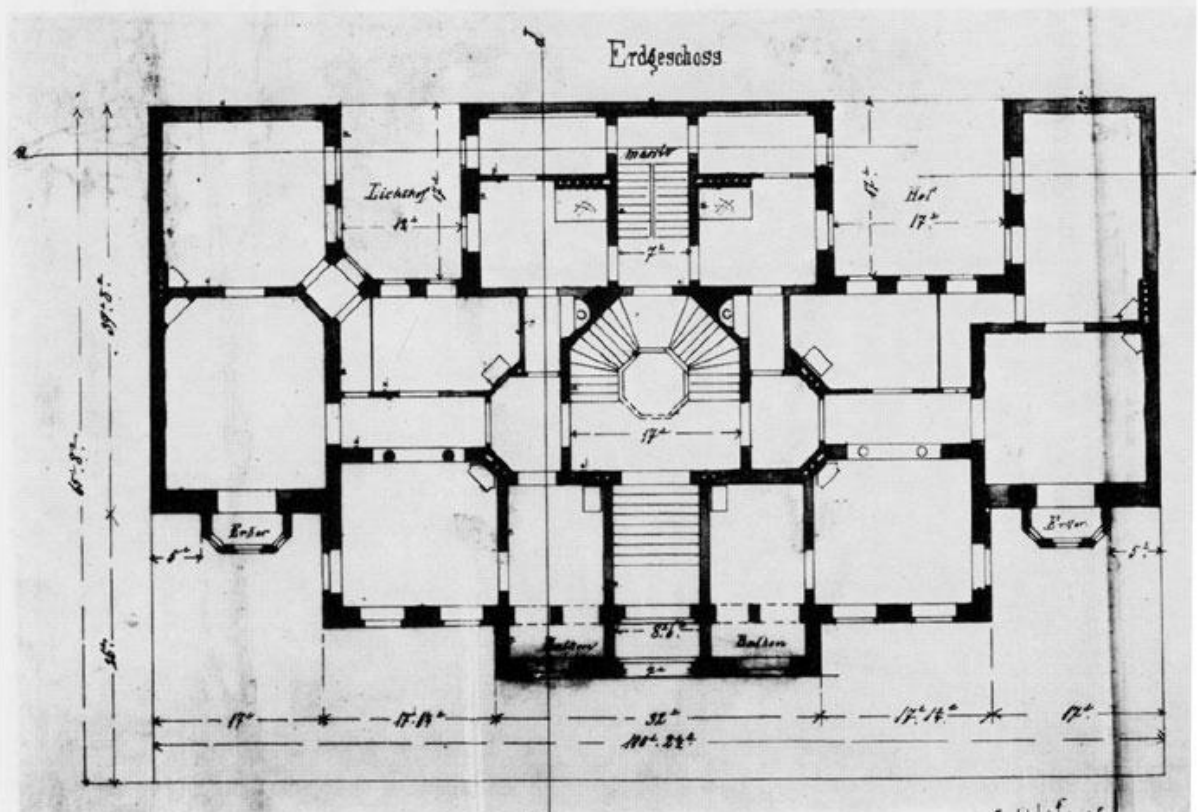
Regentenstr. 2, C. Busse, 1863-64, Bauantragszeichnung, Grundriß.
